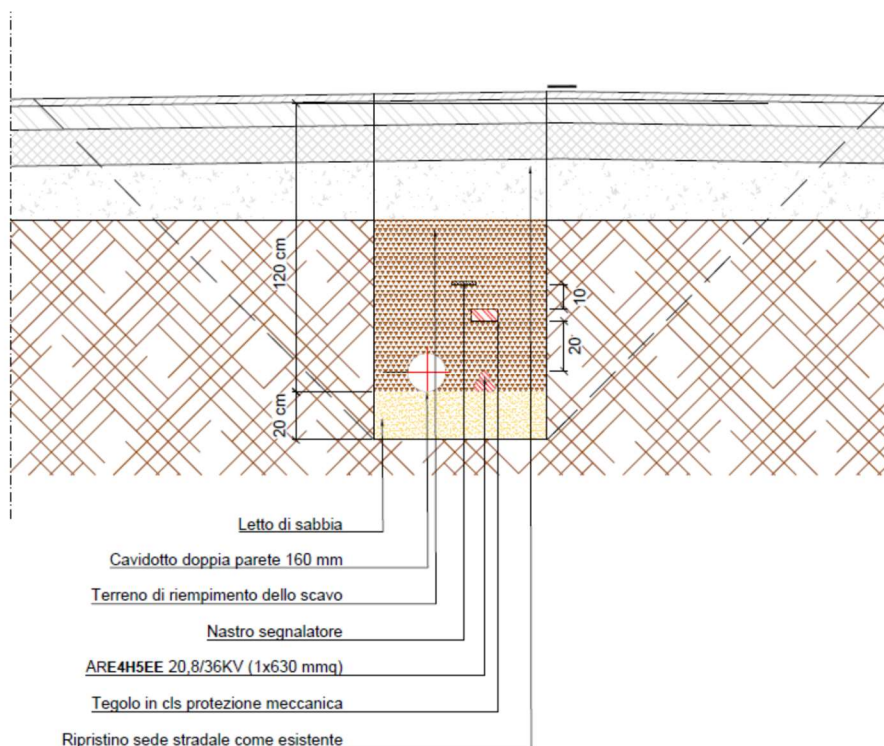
Sezione tipica di scavo per cavidotto AT su strada asfaltata pubblica
